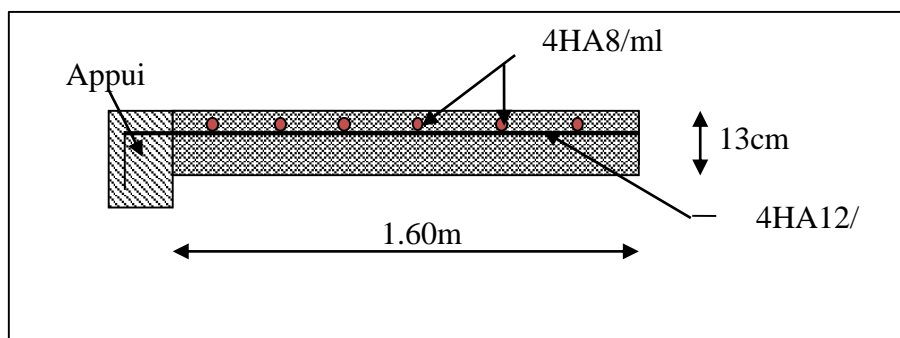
schéma de ferrailage de la dalle sur 1 appui.
